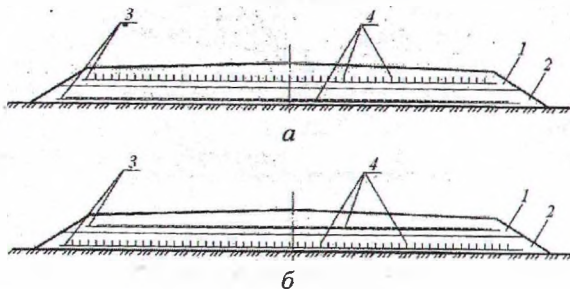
Дорожная конструкция с геотекстильной прослойкой: 1 – дорожная одежда; 2 – земляное полотно; 3 – рулонный ГМ; 4 – вертикальные полосы
